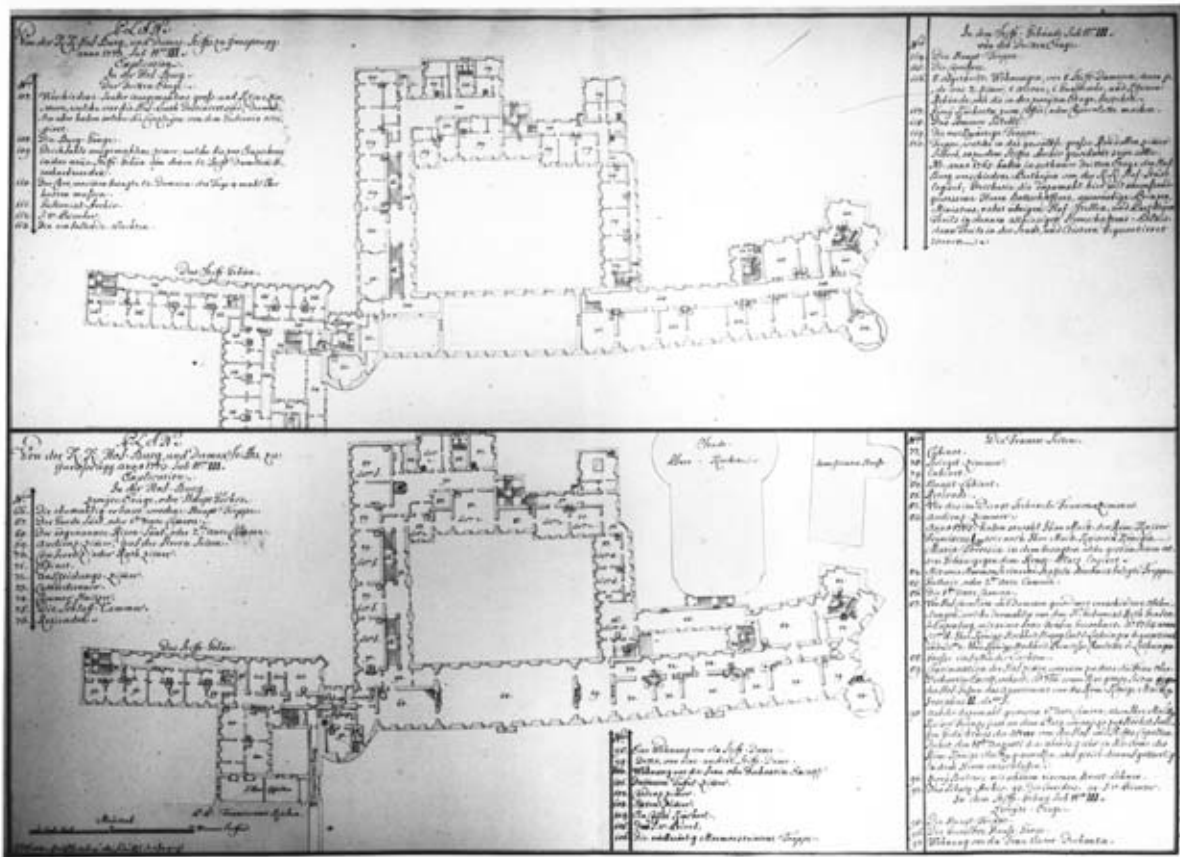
Hofburg und Adeliges Damenstift, Grundriß des zweiten und dritten Obergeschoßes, Constantin Johann Walter, 1773
